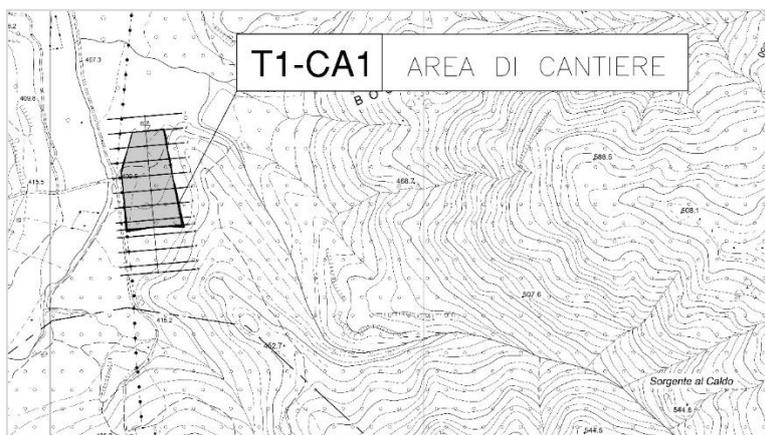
Inquadramento Planimetrico cantiere T1-CA1.
